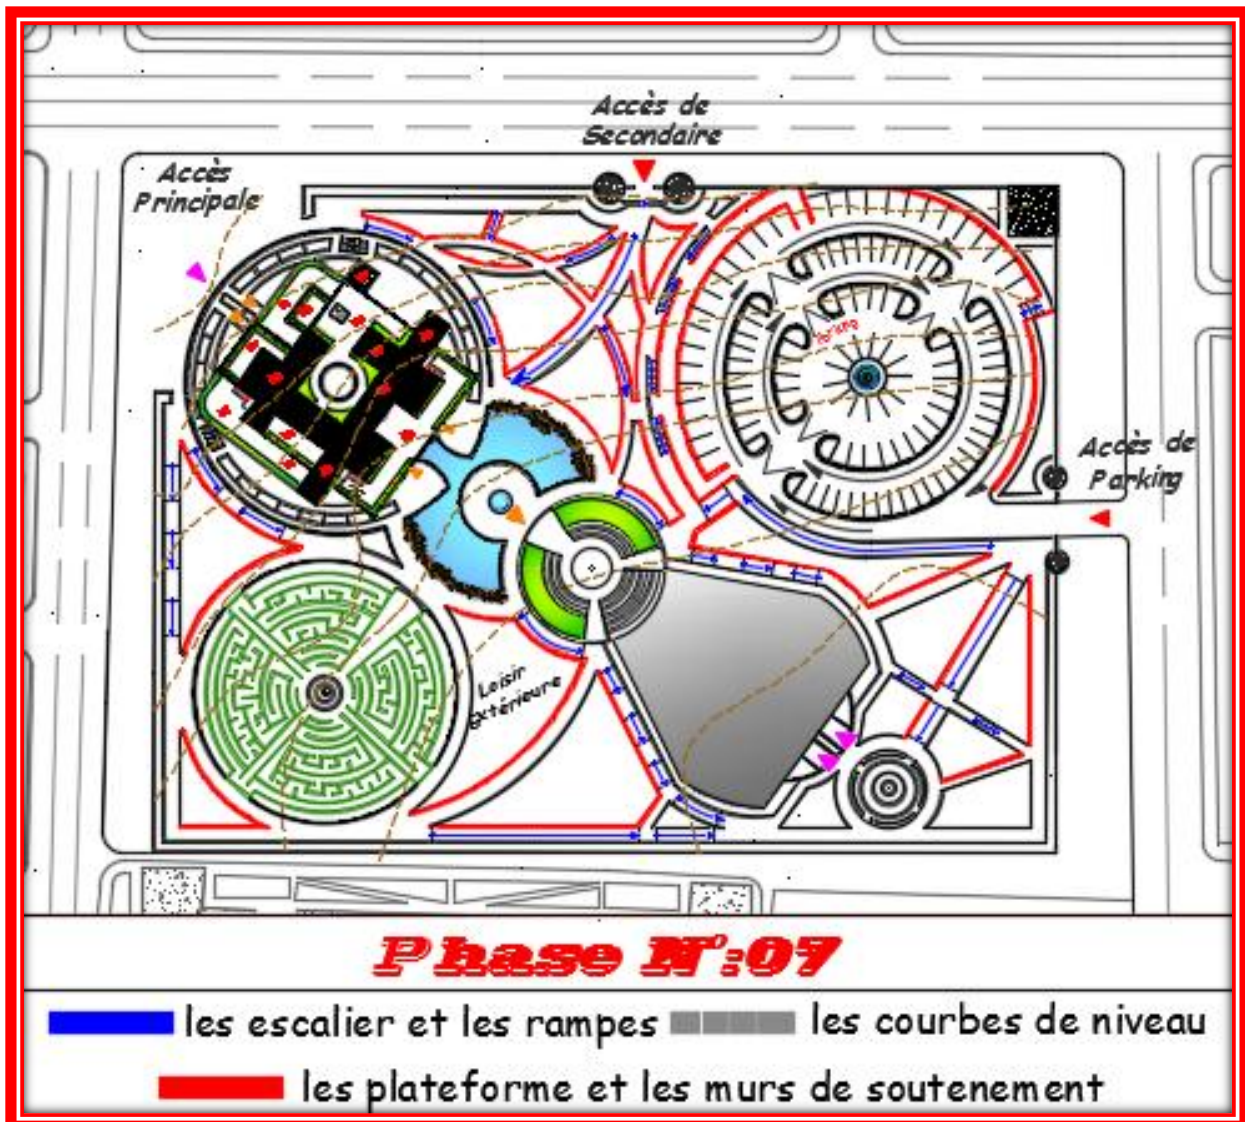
l'emplacement de rampe et escalier par rapport au courbe de niveau / source: auteur
